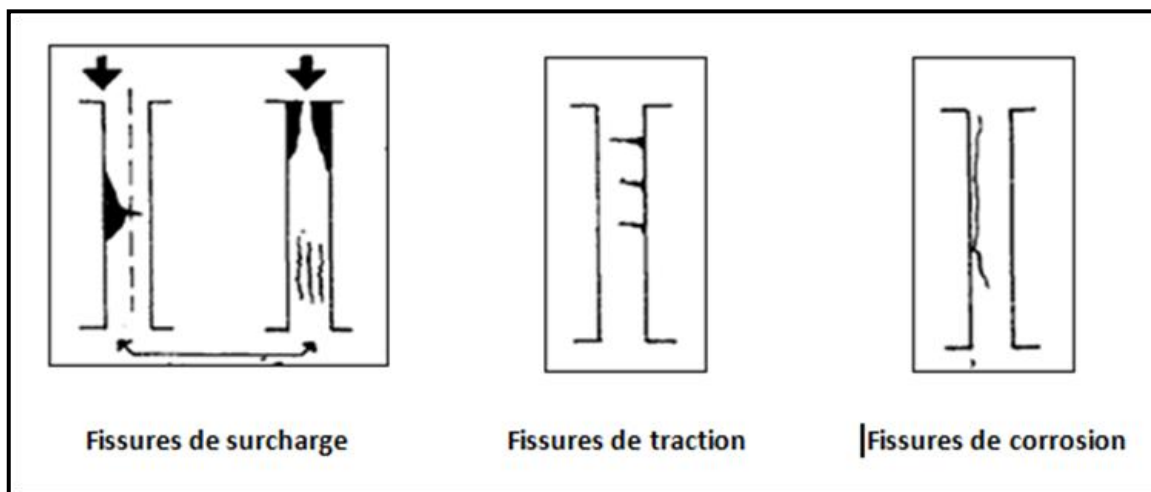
Fissures qui apparaissent dans les poteaux en BA.
